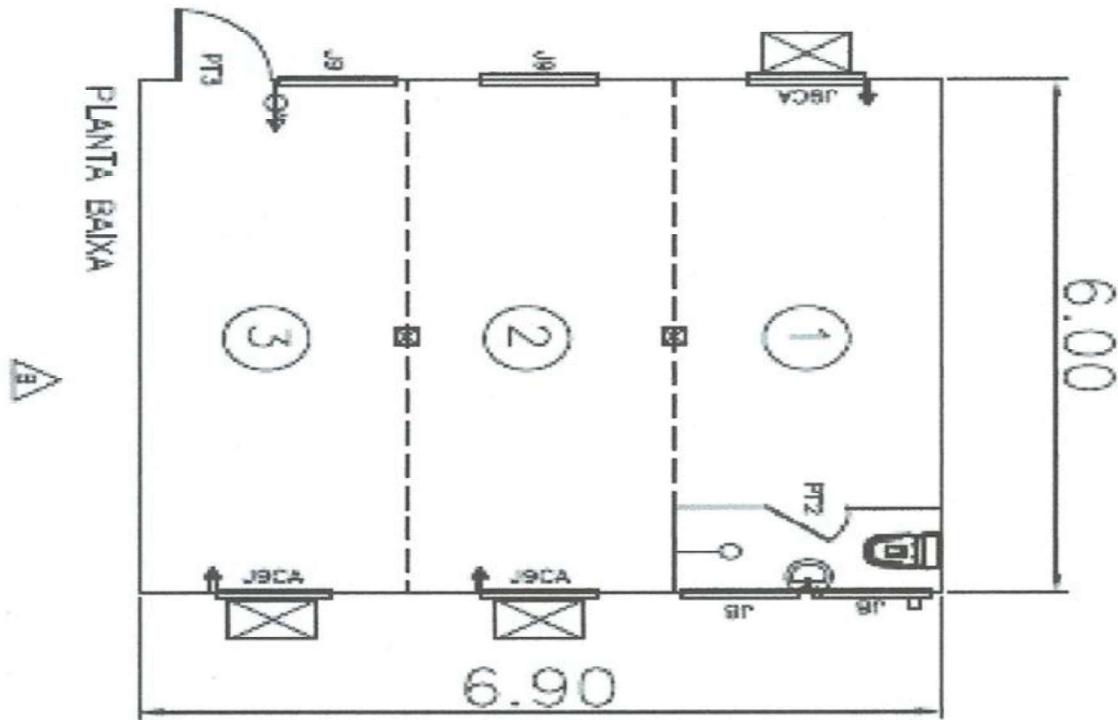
Modelo conceitual do container - Dimensões da planta.
